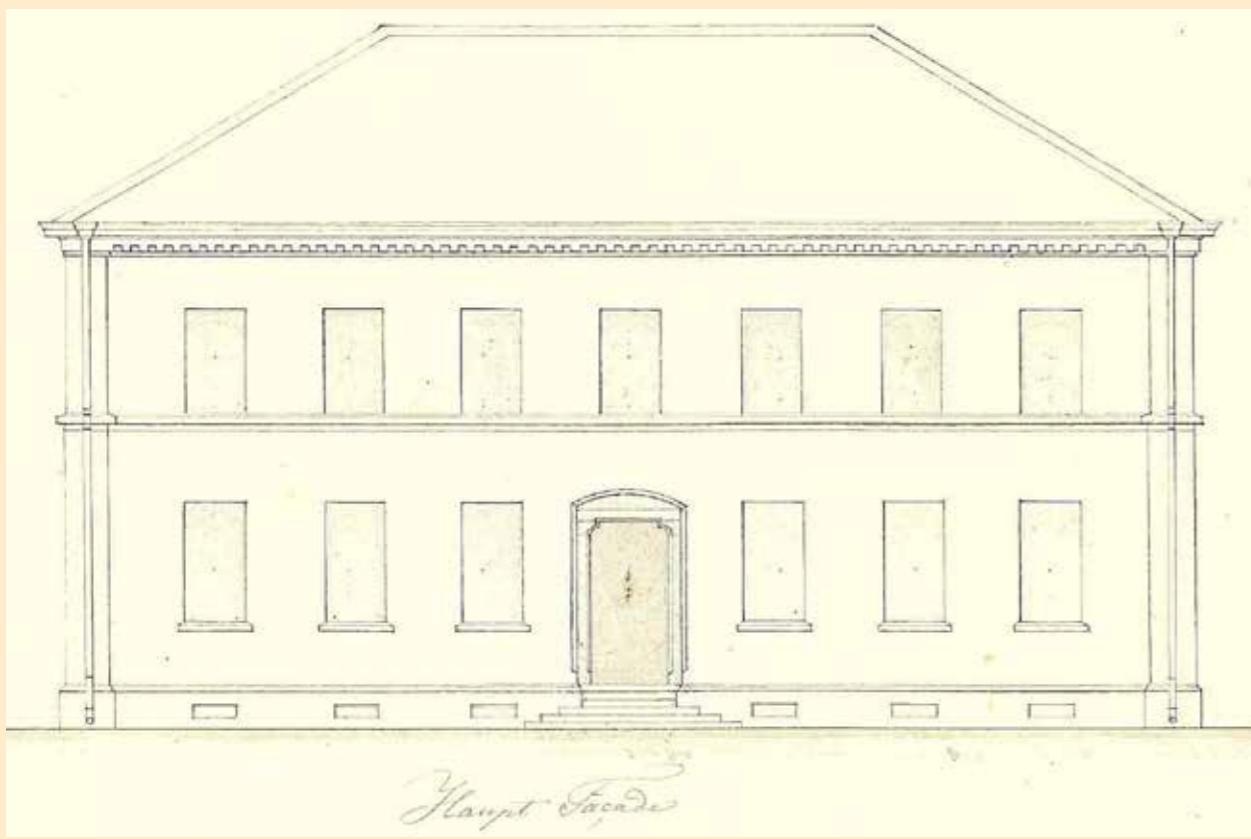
Hauptfassade für ein Schulhaus. Plan von Heinrich Hübsch, o.D. Stadtarchiv Weinheim.
